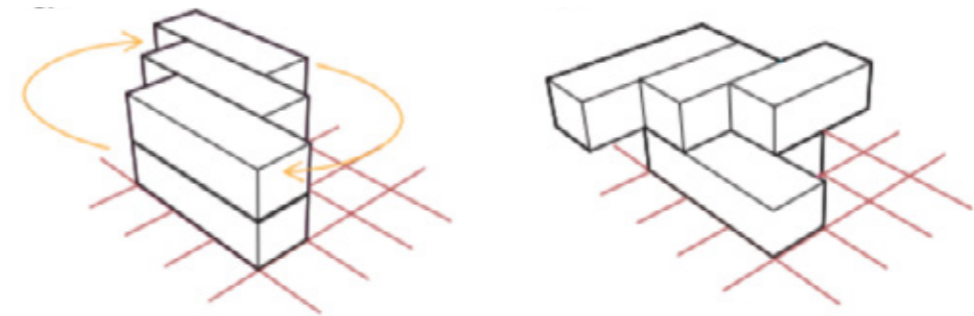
Diagramas de articulación y soporte arquitectónico - estructural barrial en altura. Fuente: Taller 8. J. Guerra.
